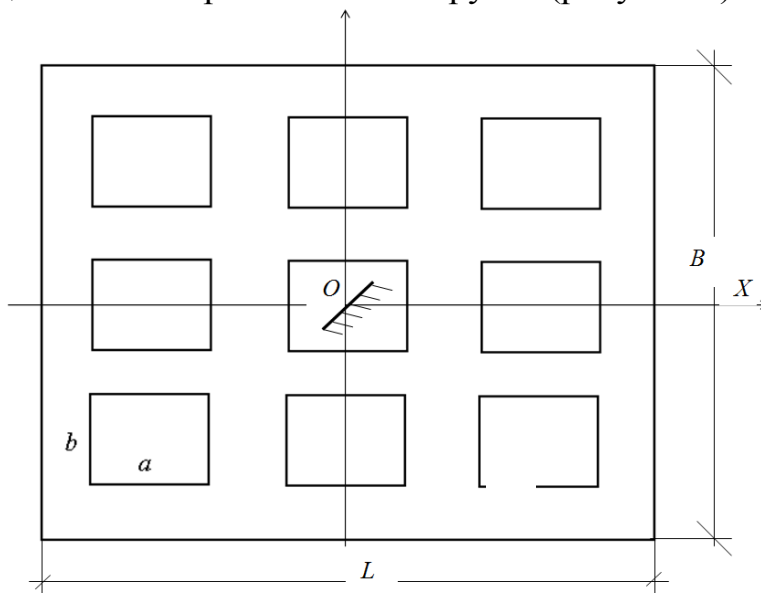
Прямоугольная фундаментная плита с отверстиями или сетчатая плита
